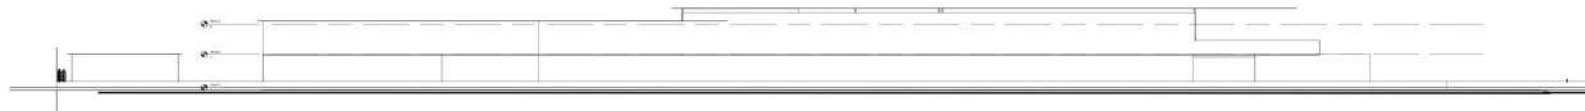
,77,78 PLANOS DE ALBAÑILERIA
